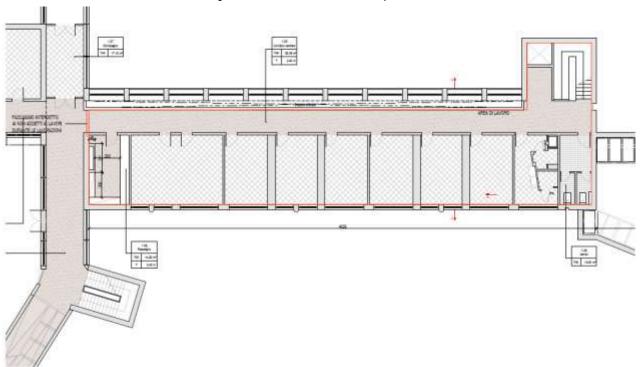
Particolare area di cantiere lotto 2 - piano primo
